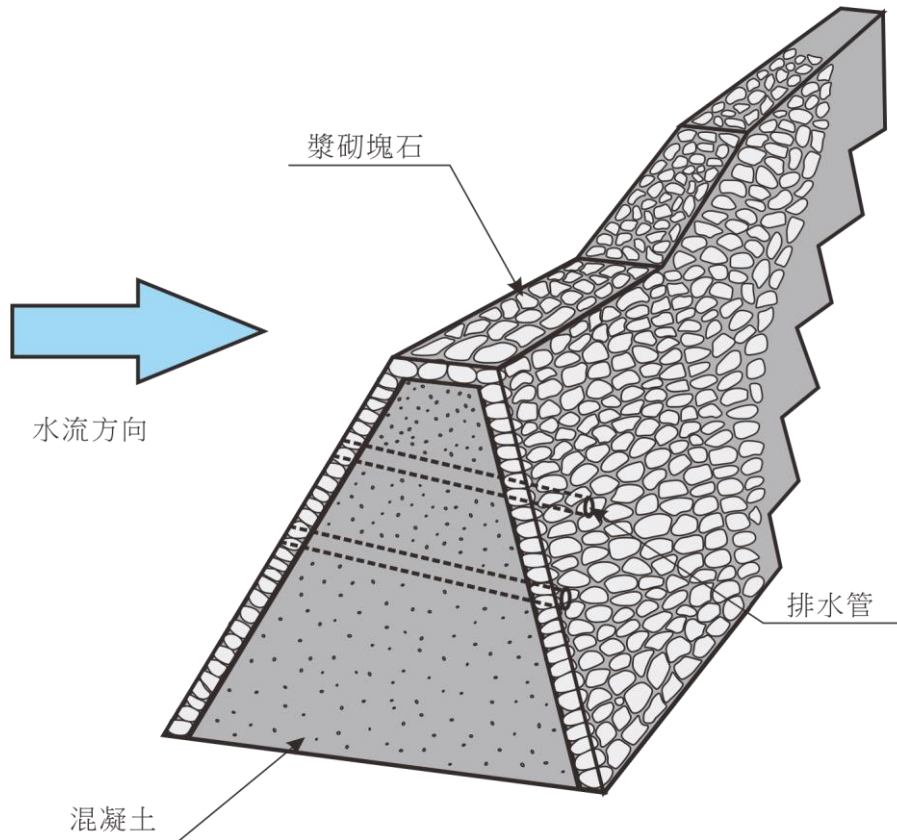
砌石壩面混凝土填心壩剖面示意圖
